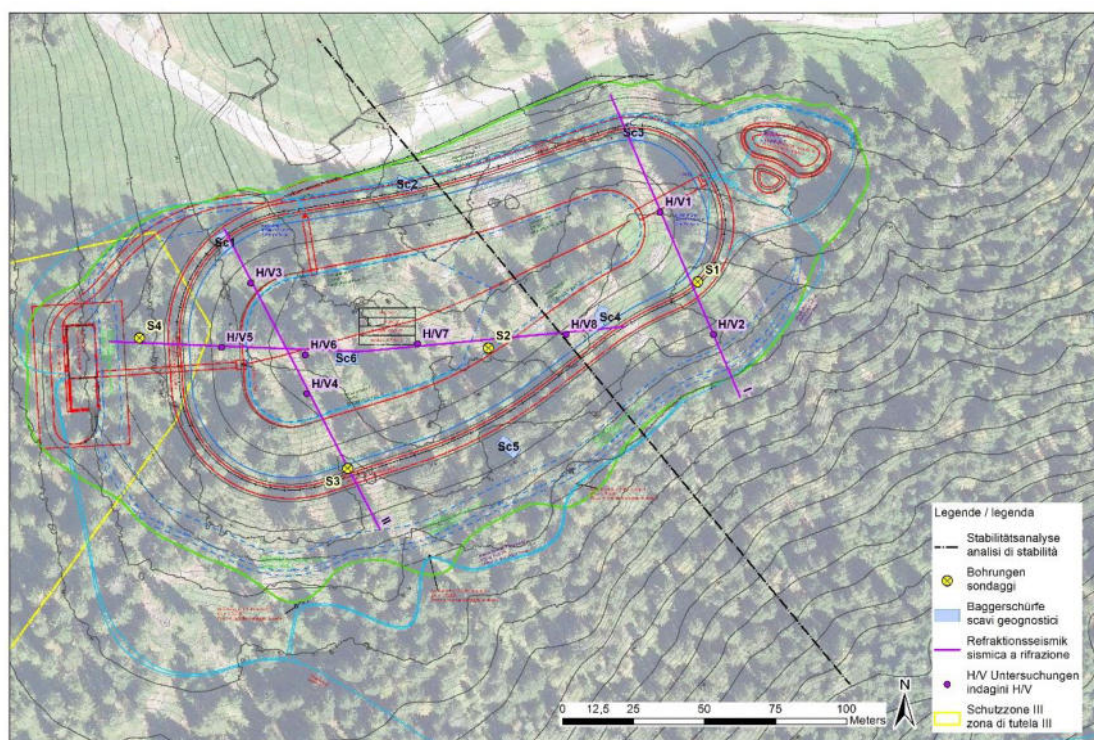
Orthofoto mit Lokalisierung des Schnitts 1 / ortofoto con localizzazione della sezione 1
